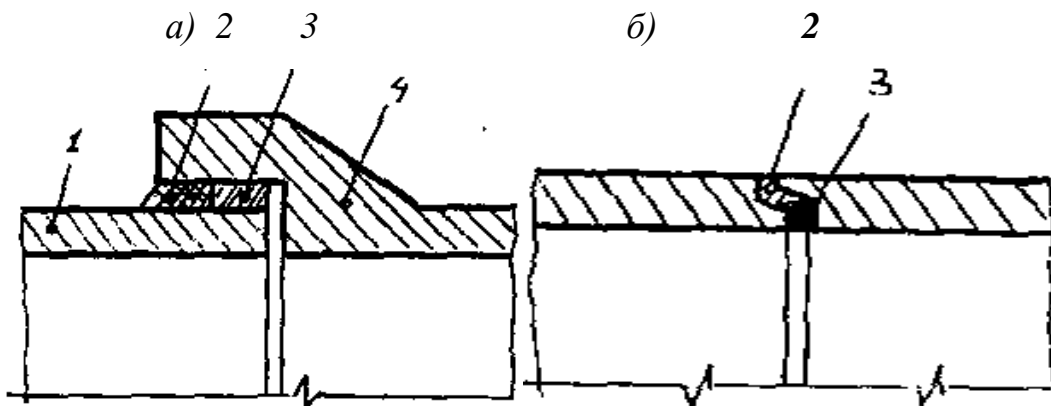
Схема стикового з'єднання азбестоцементних труб
